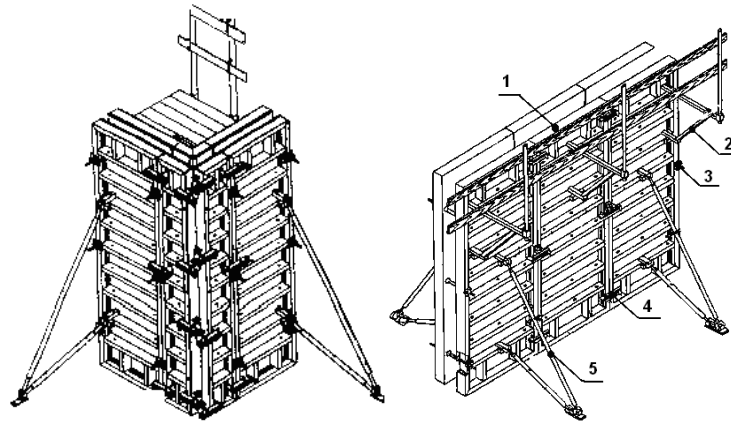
Схеми опалубки вертикальних конструкцій будівлі.
